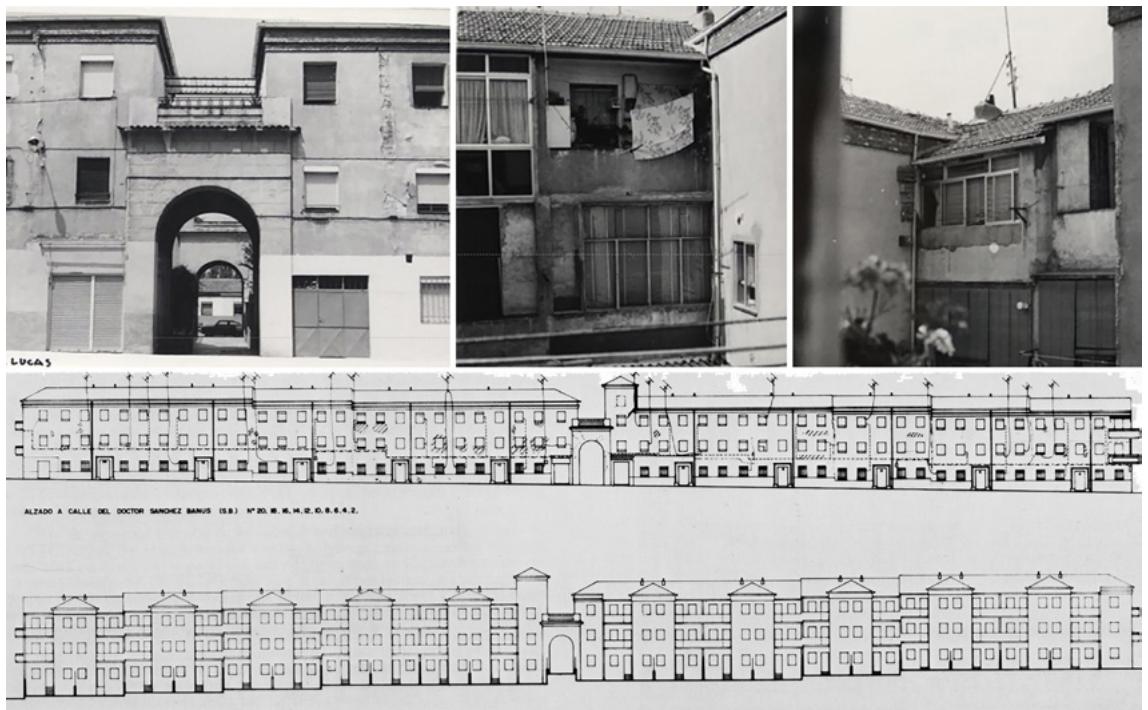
Izq. 1975, fachadas de la calle Pintor Lucas antes de la rehabilitación. Centro y drcha., 1975, fotografías de la ocupación de las zonas aterrazadas modificadas. Abajo, planimetría realizada por el estudio Alas y Casariego para el proyecto de ejecución y rehabilitación básica de la Colonia Municipal Salud y Ahorro. [Colonia Moscardó]
